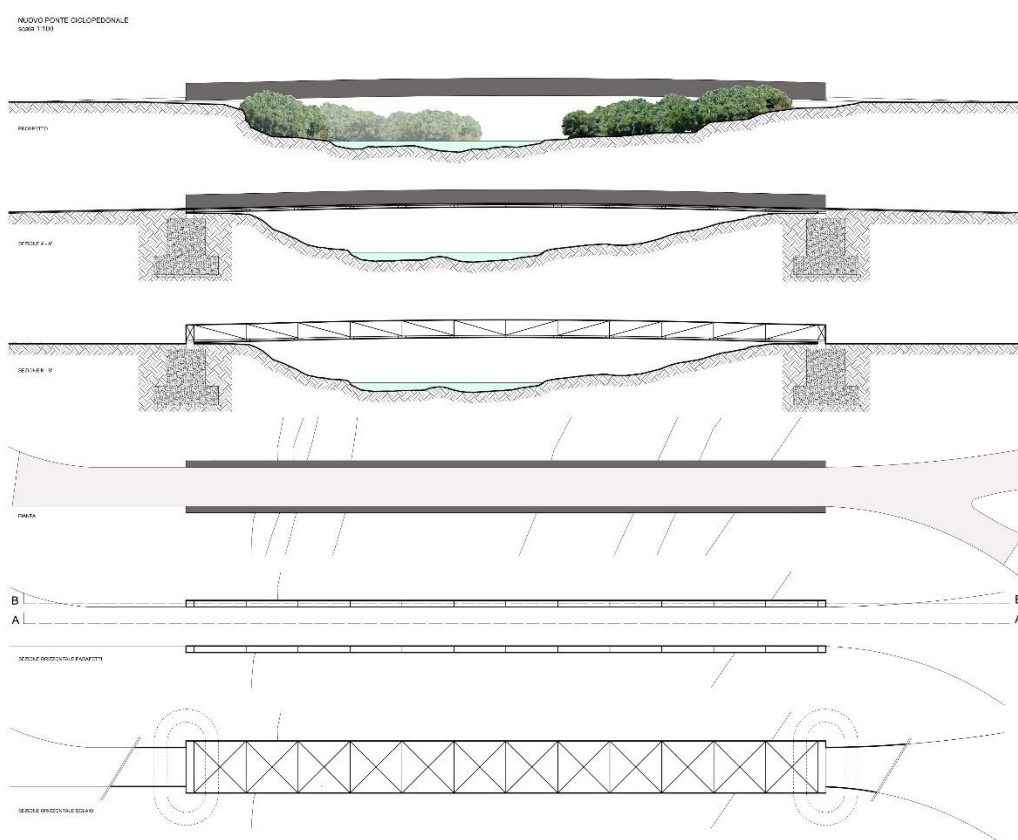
Prospetti e sezioni del ponte ciclopedonale
